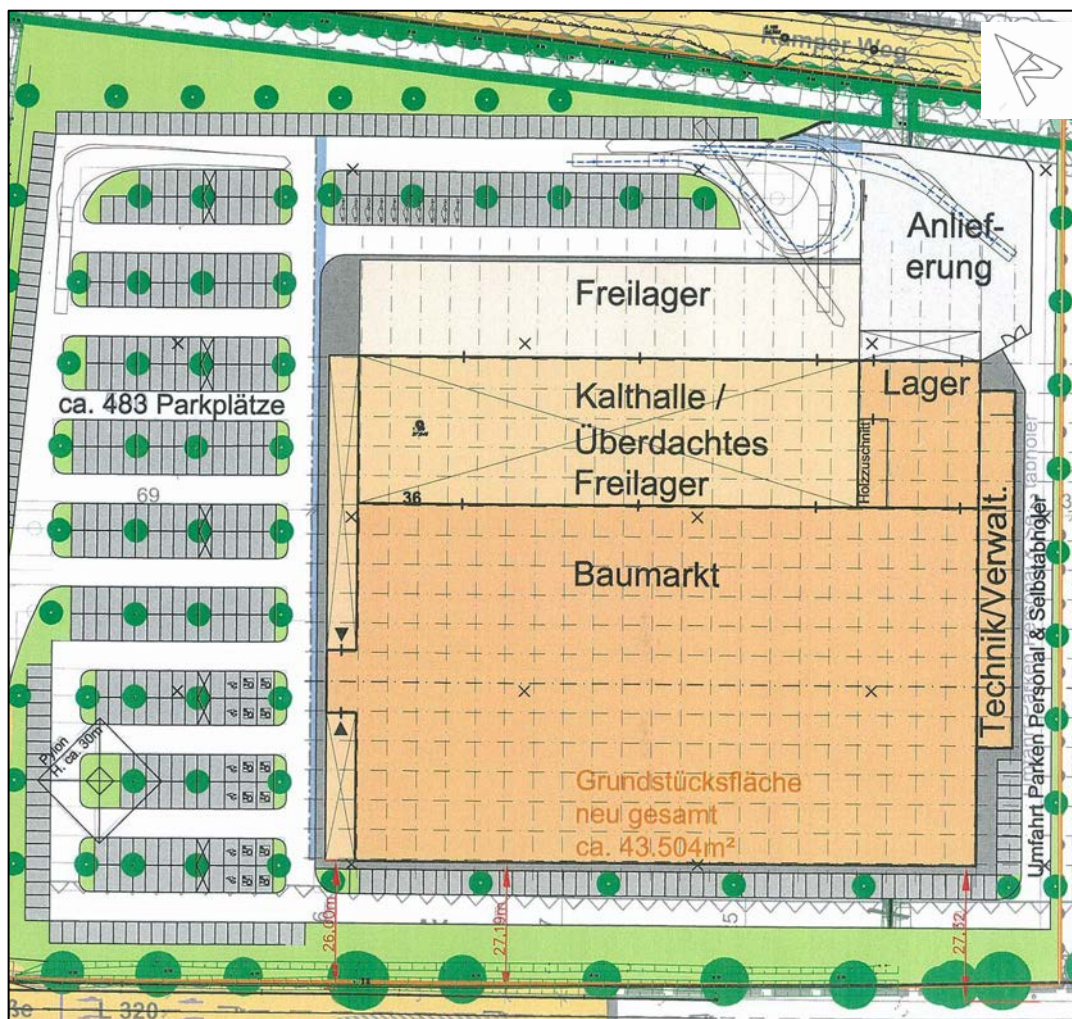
Lageplan Globus, Stand 07.12.2012
